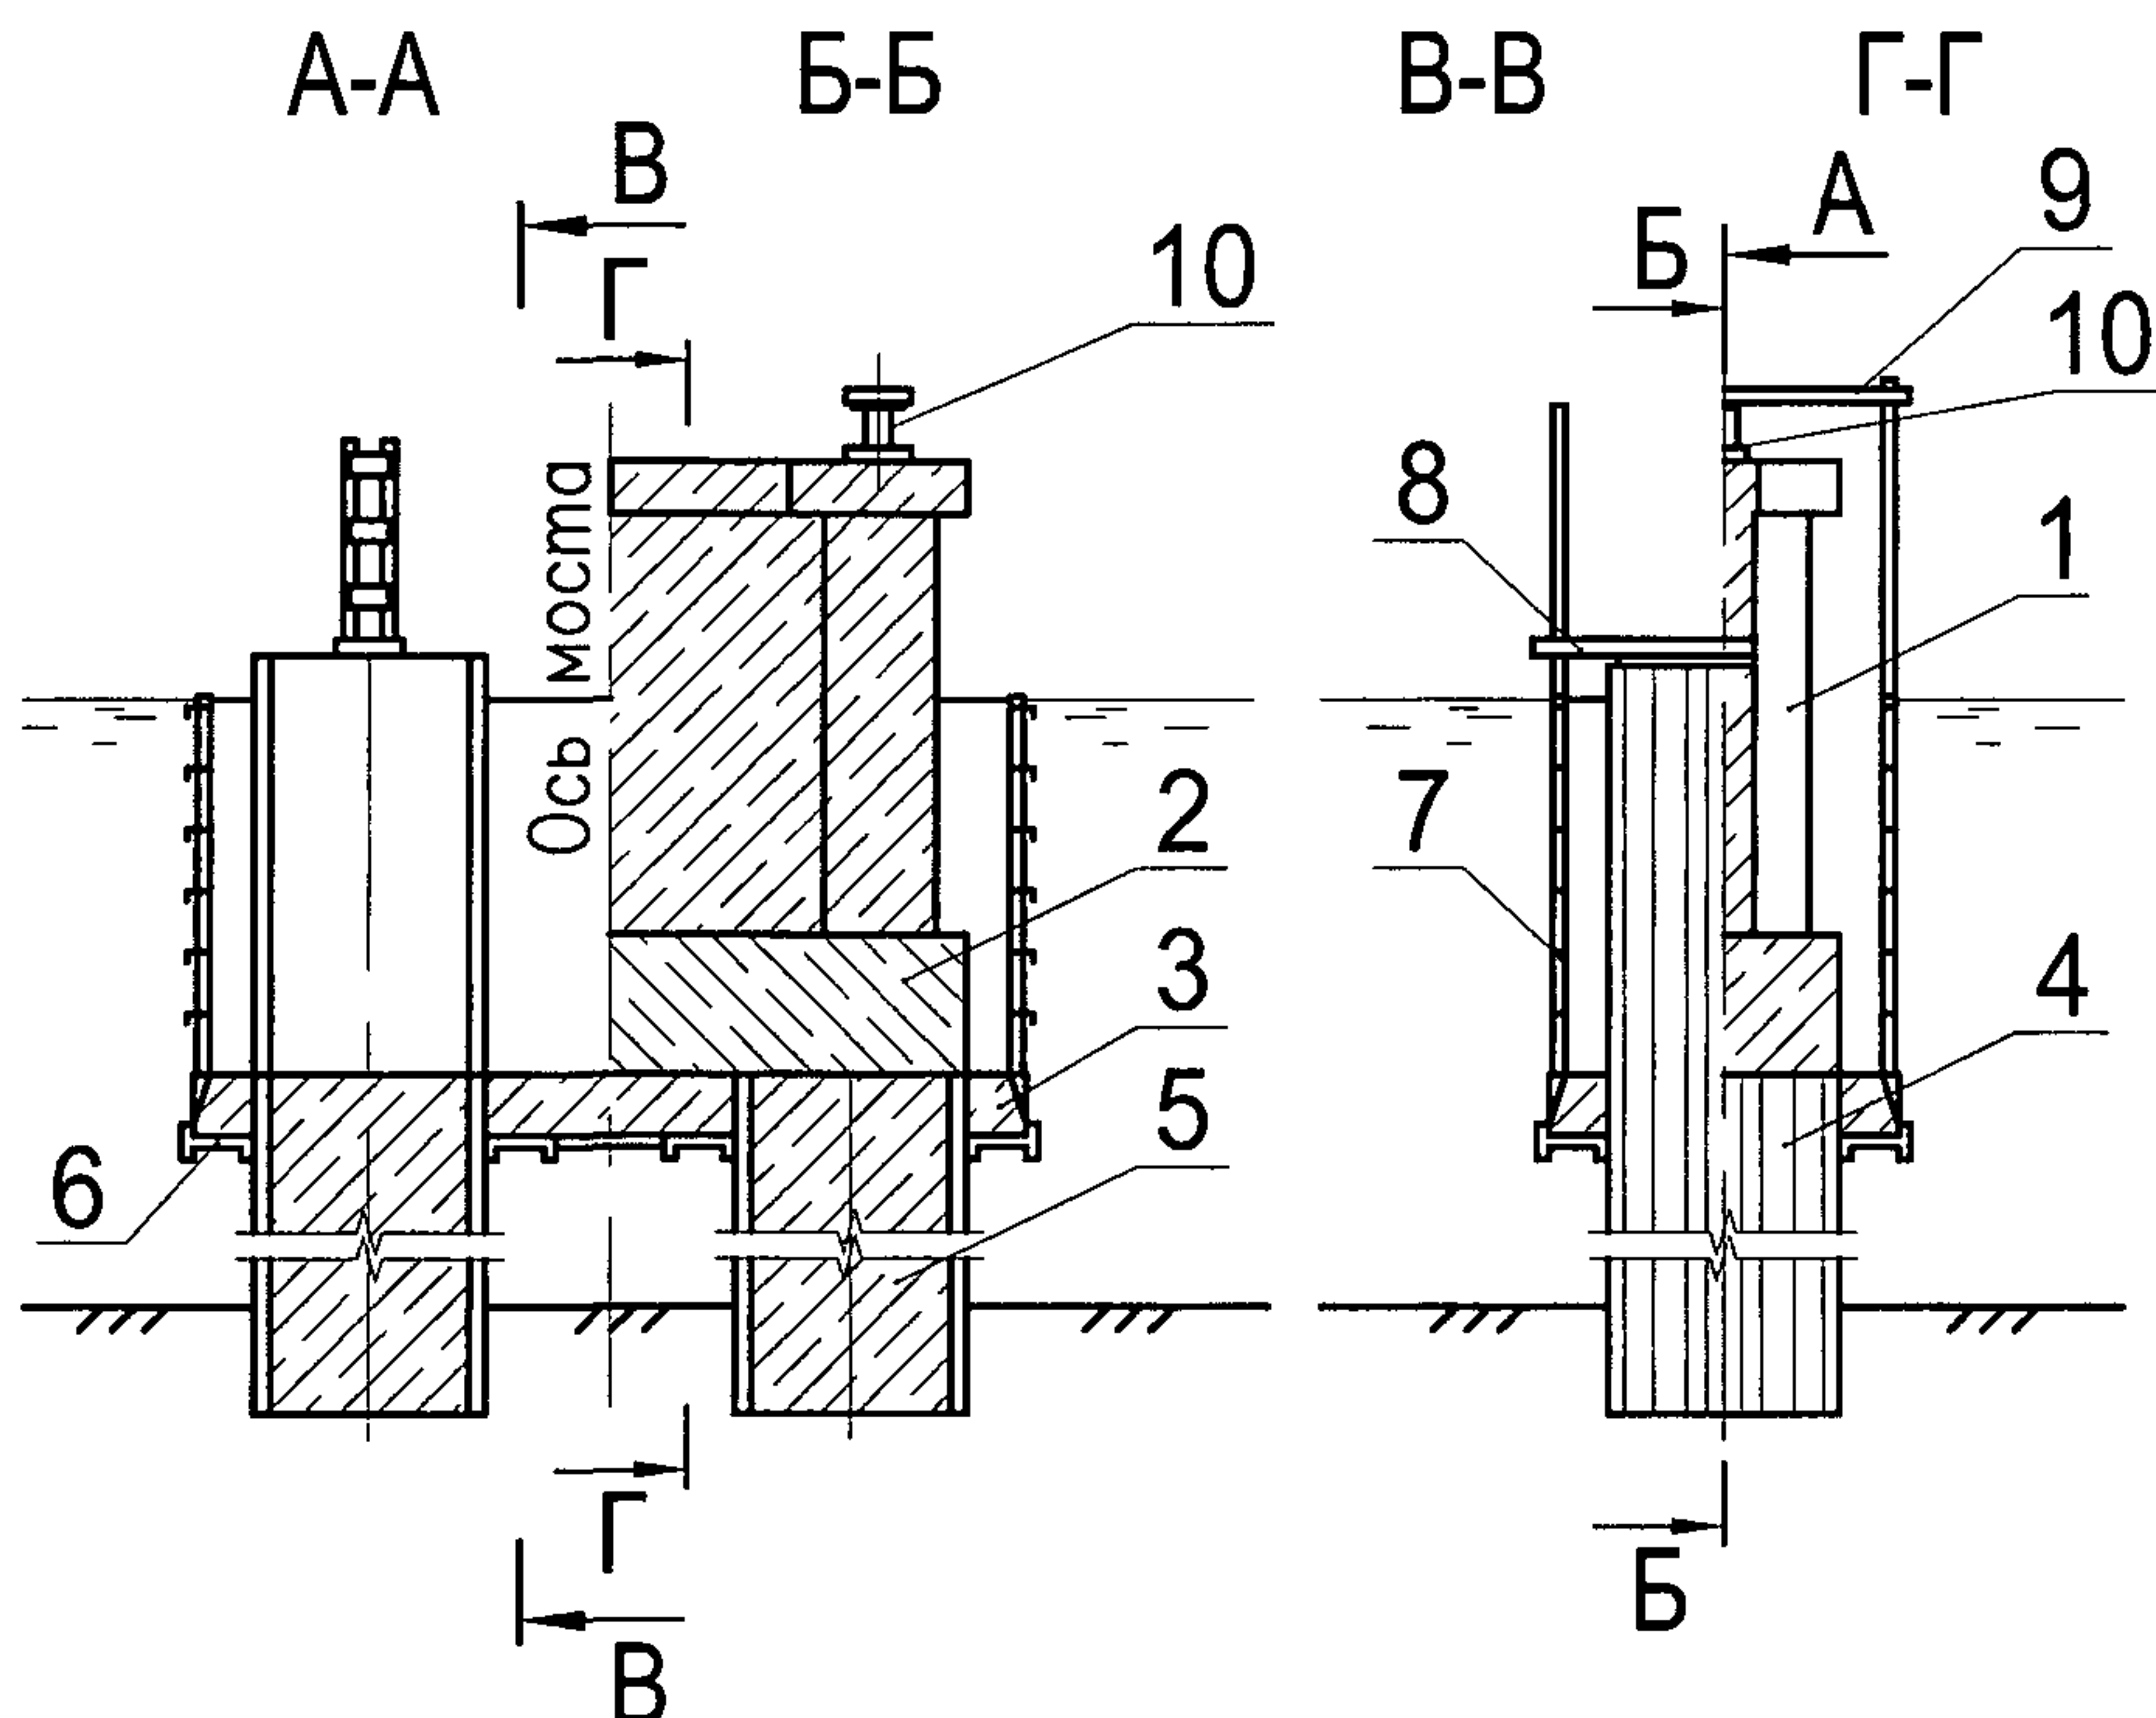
Металлическое щитовое ограждение ростверка
